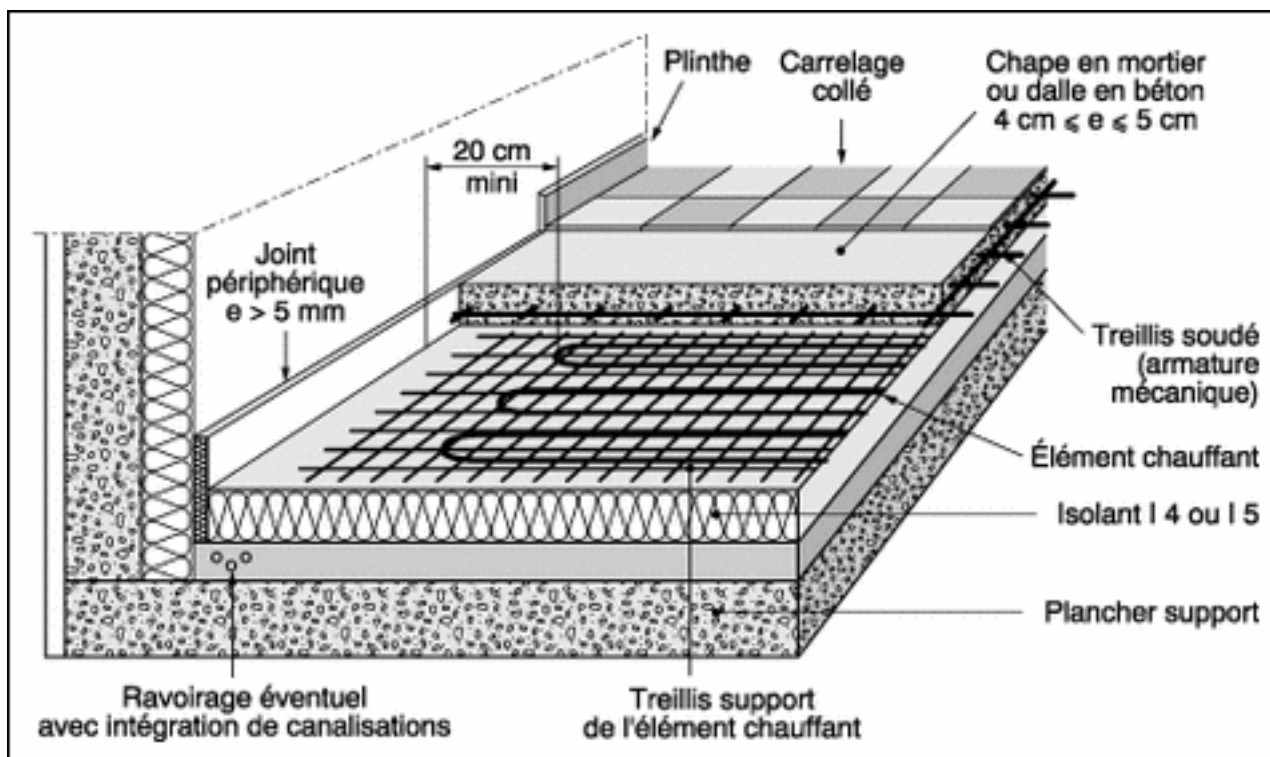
Câble chauffant reposant sur un isolant incompressible, recouvert par une chape en mortier ou une dalle en béton destinée à recevoir un revêtement de sol collé (par exemple : carrelage)
